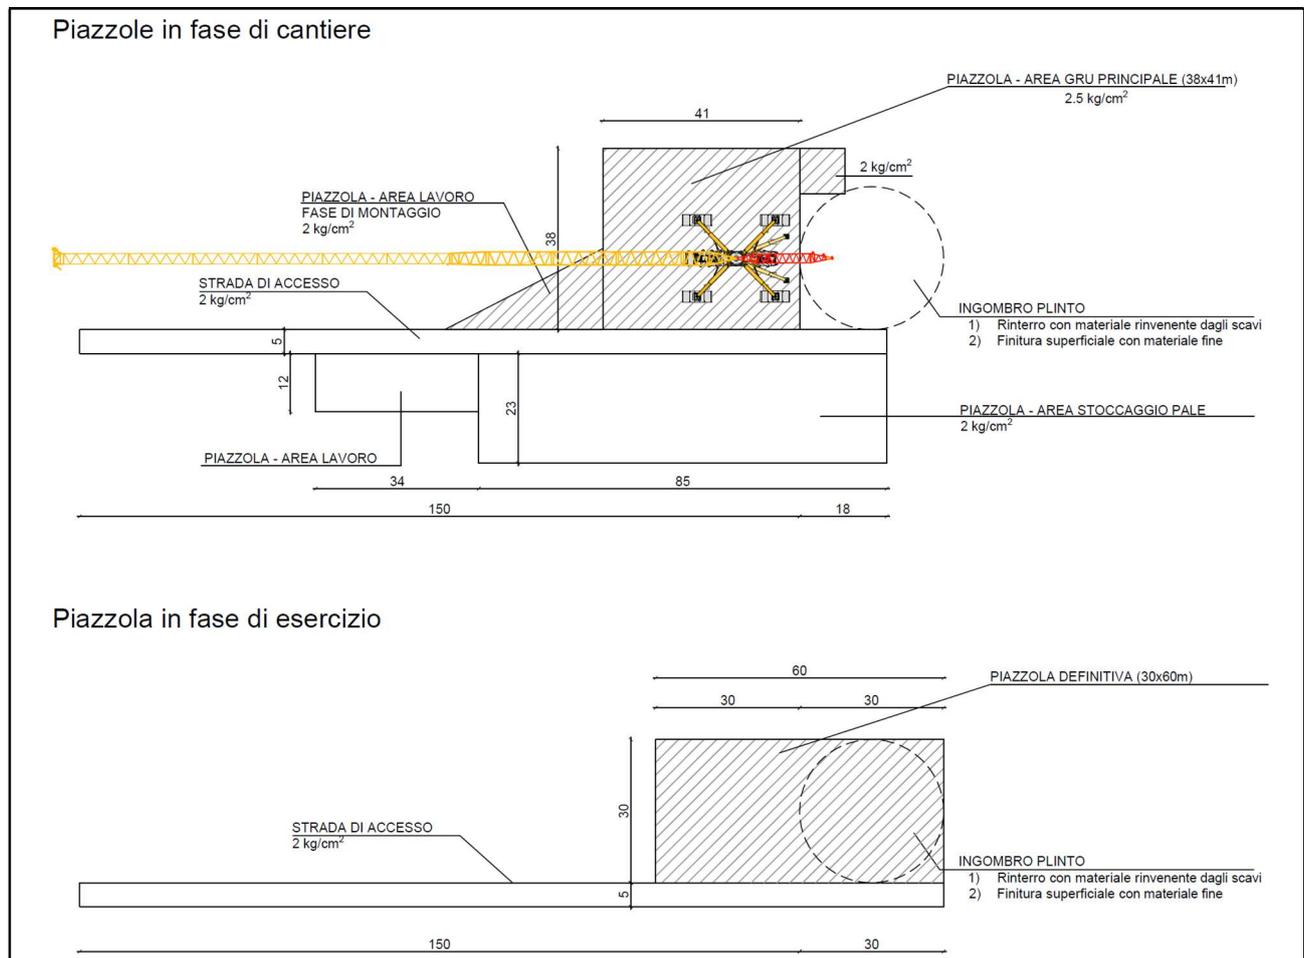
Planimetria piazzola tipo per la fase di installazione e fase di esercizio e manutenzione
